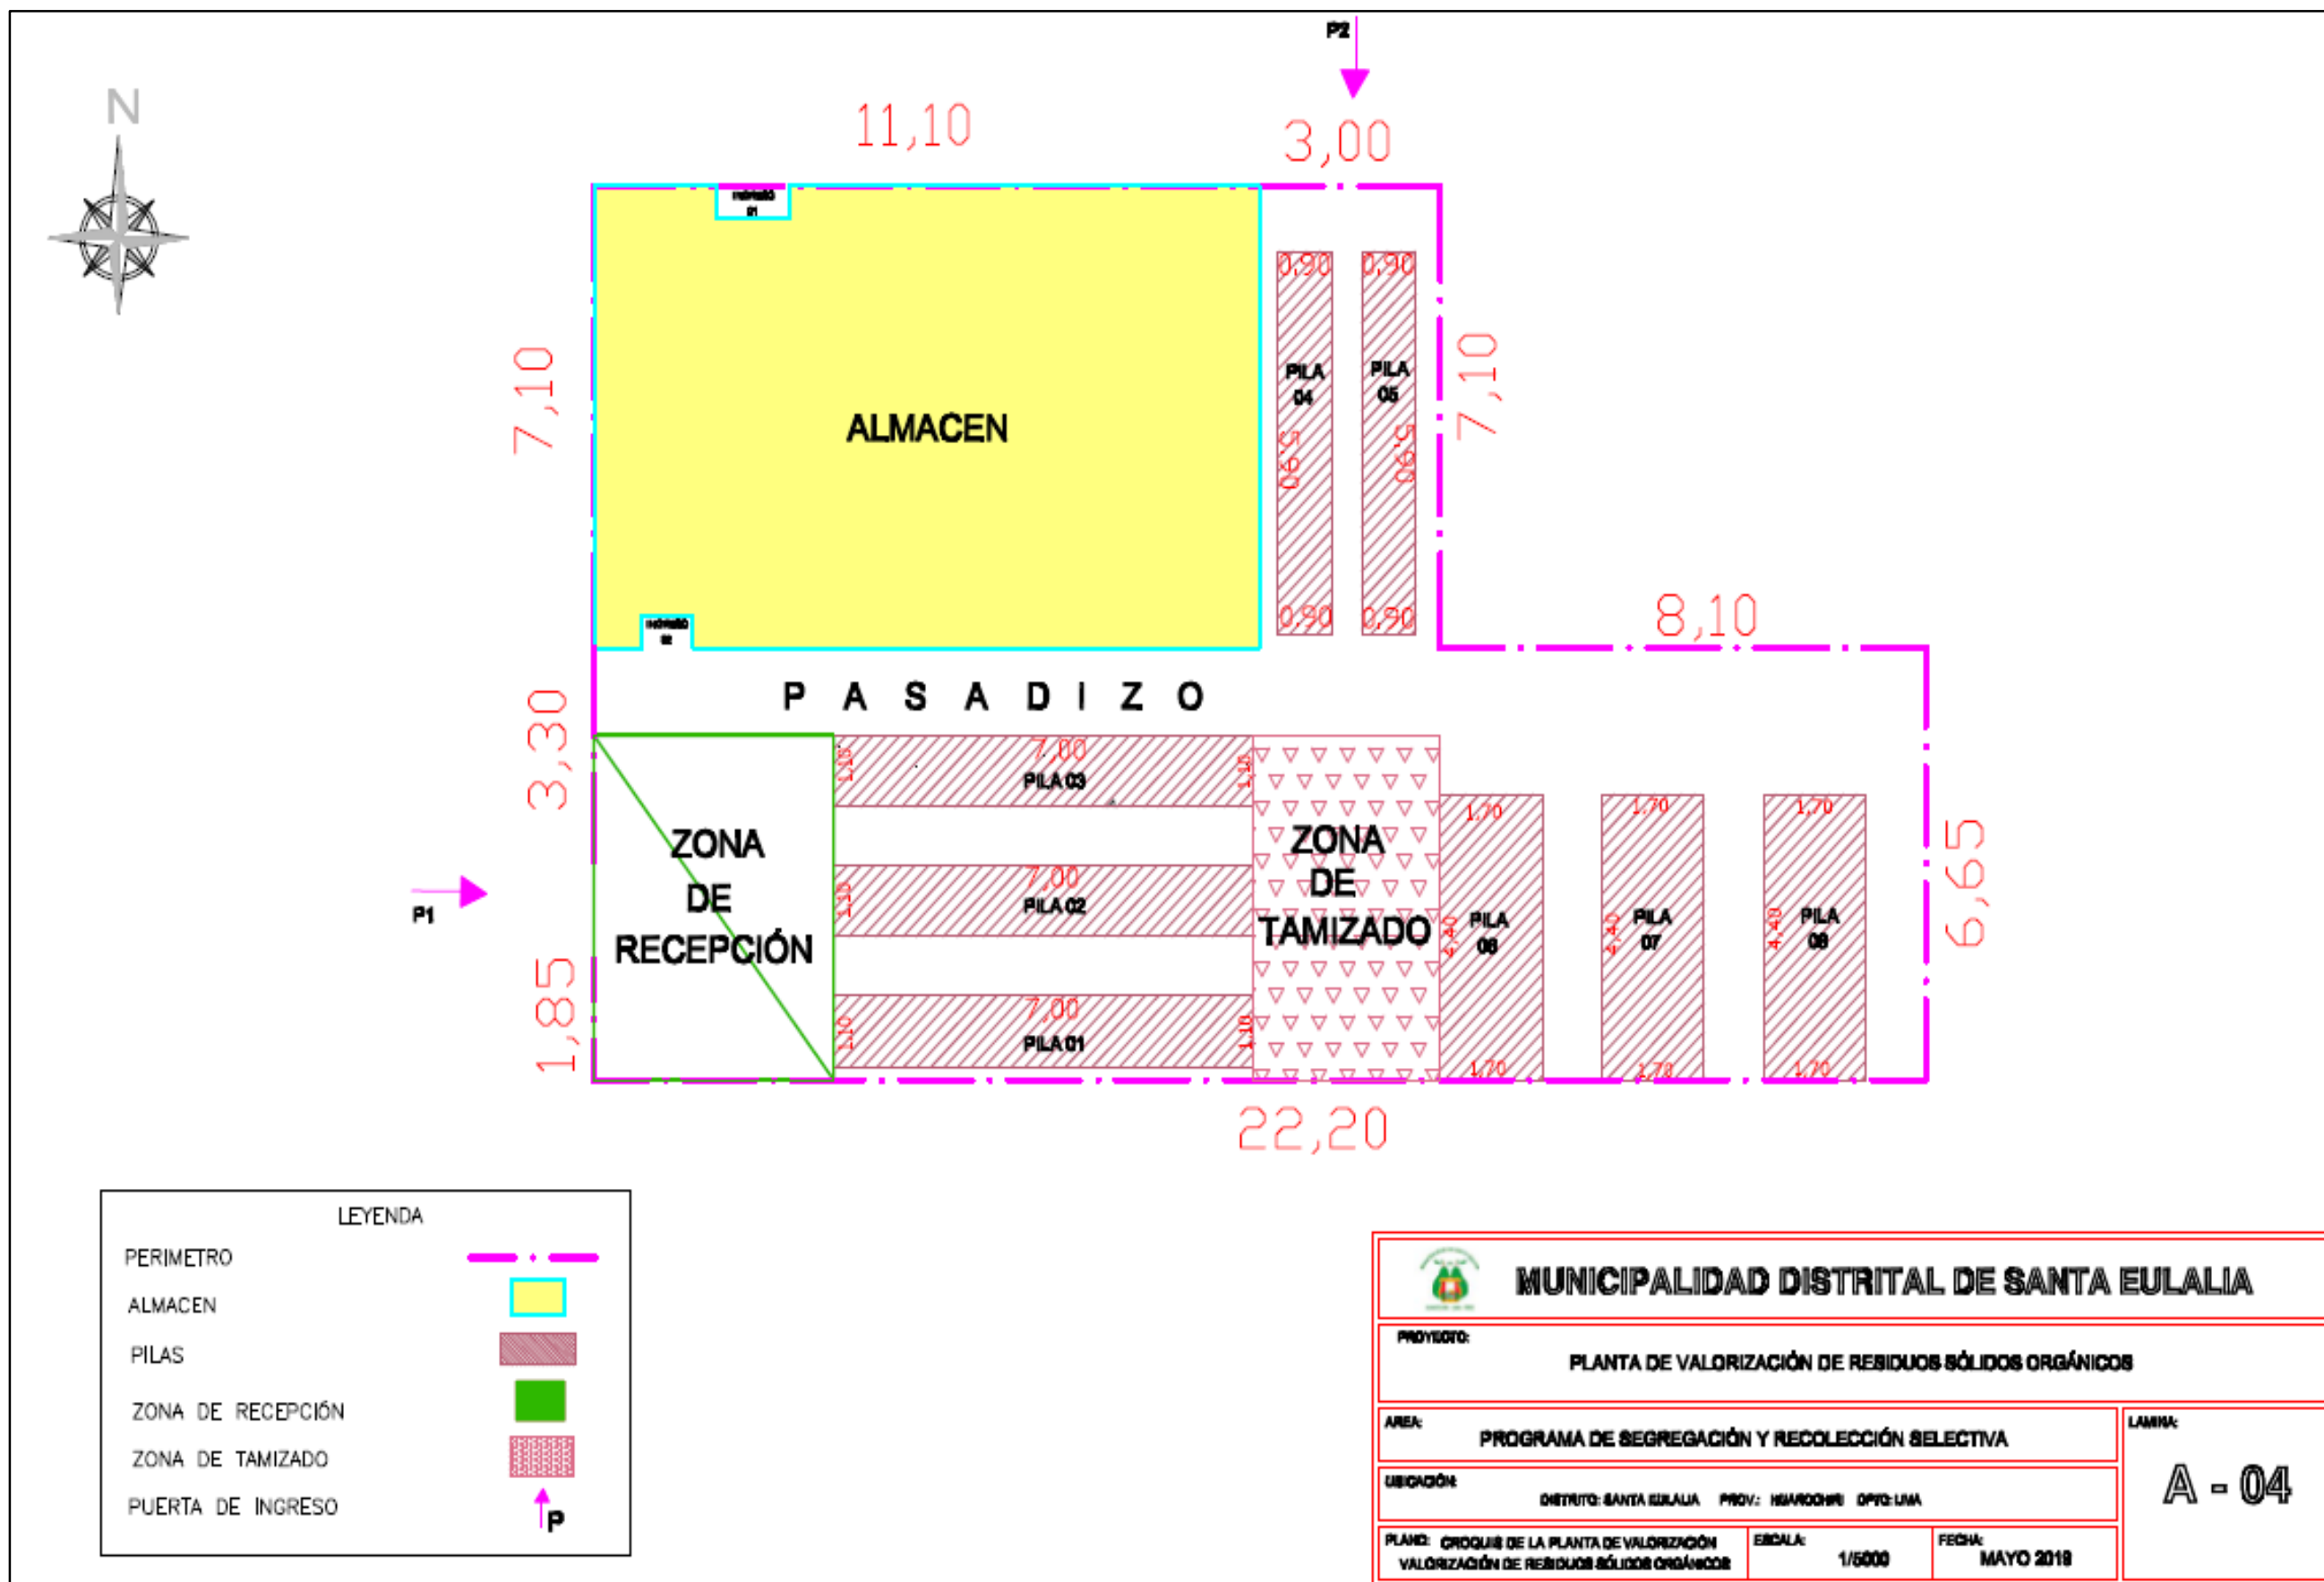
Plano de distribución de áreas de la Planta de Valorización.
